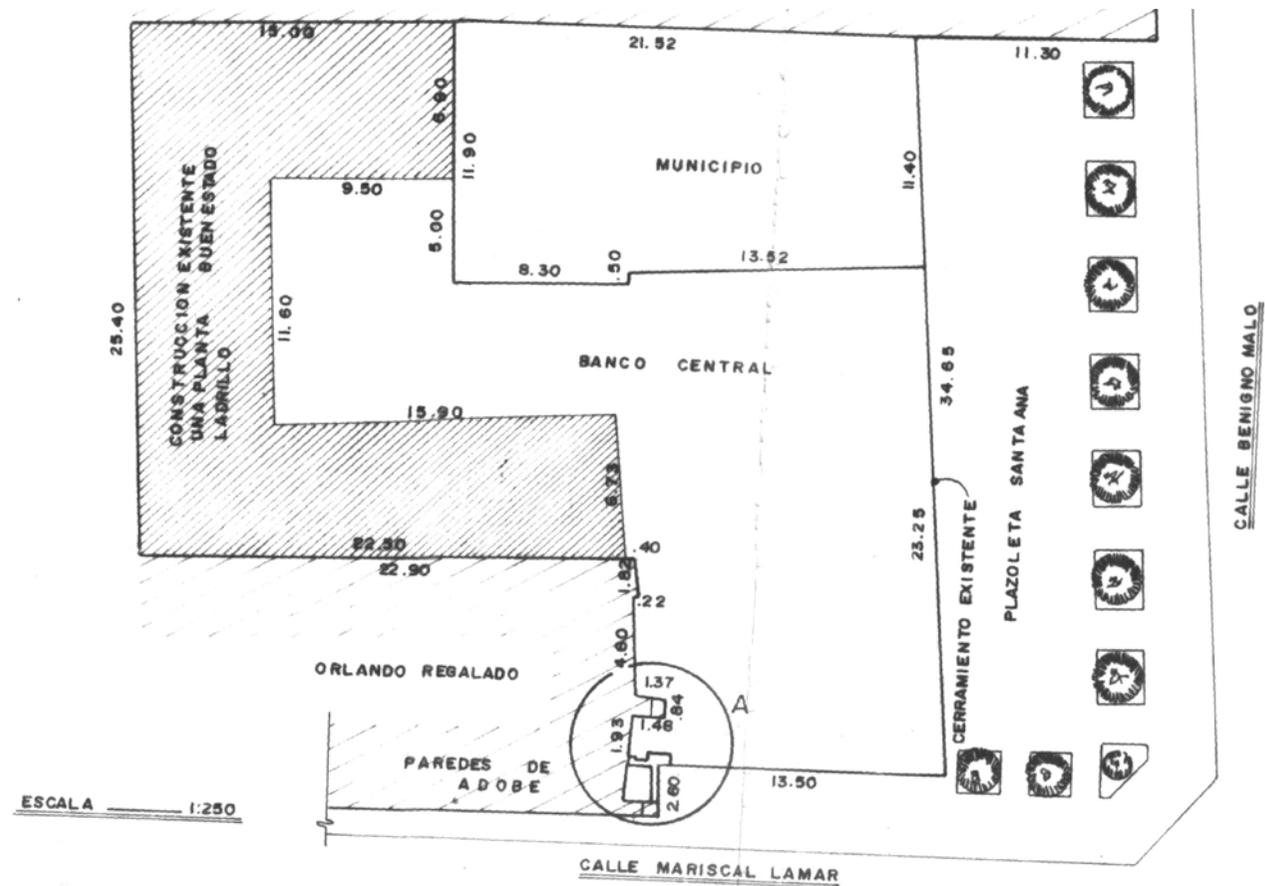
Planta arquitectónica de la Plaza Santa Ana, 1994
